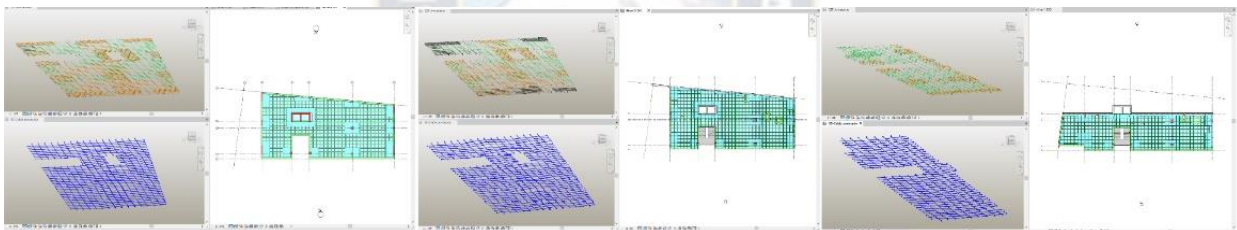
Tendones y aceros pasivos en modelo central – Revit - Fuente: Elaboración propia
